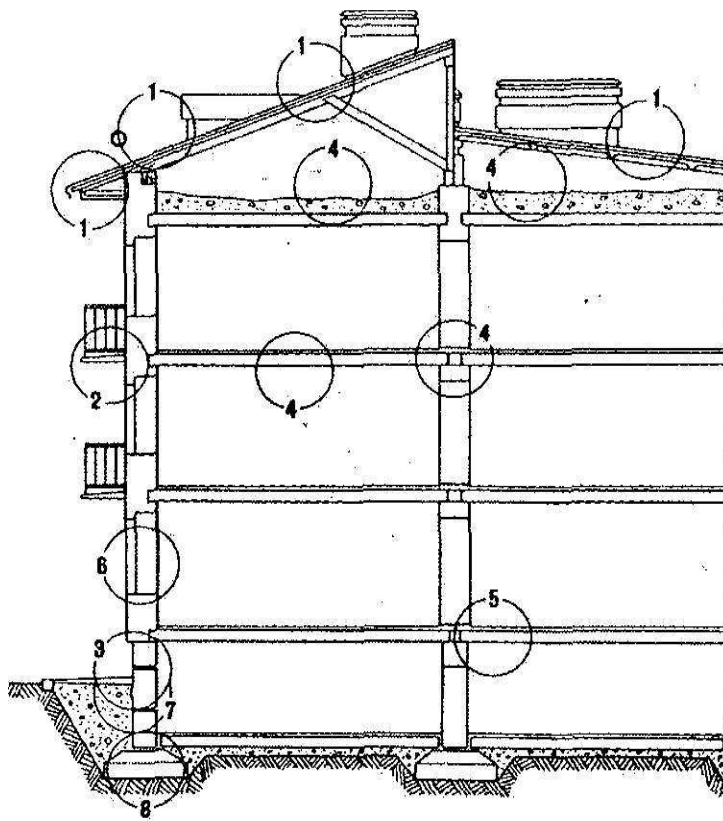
Найхарактерніші слабкі місця, з яких починається руйнування конструкцій будівлі: 1 - на даху: місця сполучення покрівлі із трубами й іншими надбудовами, з лійками внутрішніх водостоків; карнизи, розжолобки, утеплювач, захисне фарбування покрівлі; 2 - на стіні: стики панелей, закладні деталі й зв'язки, утеплювач тришарових панелей, простінки й перемички, місця проходження водостоків, захисне покриття; 3 - на цоколі: місця сполучення стін з вимощенням, лицевальний захисний шар, горизонтальна гідроізоляція; 4 - в перекритті: середина прольоту, опорна частина, зони зволоження й зосередження навантажень, шви між панелями, місце проходження труби; 5 - в колонах: місця спирання балок і настилів, вертикальні грані (ребра); 6 - у воротах, вікнах, дверях: портали й коробки, петлі й запори, нижні обв'язки, захисне покриття; 7 - у фундаментах: місця сполучення з вимощенням, зона зволоження й зона промерзання ґрунту; 8 - в
